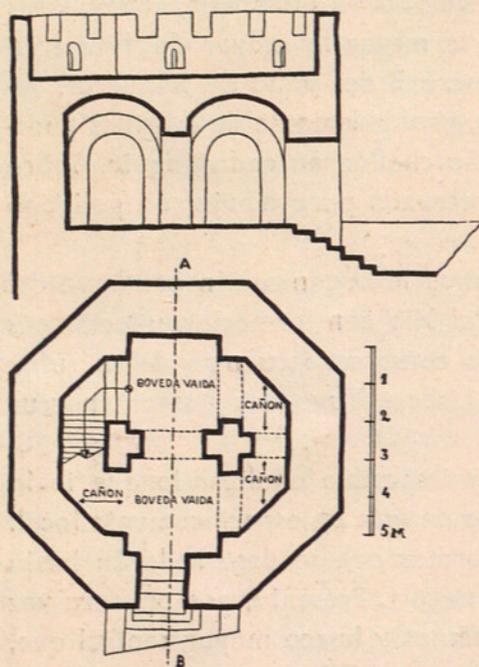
PLANTA Y SECCIÓN DE LA TORRE LLAMADA REDONDA DE CÁCERES. (Según A. Marchena.)
